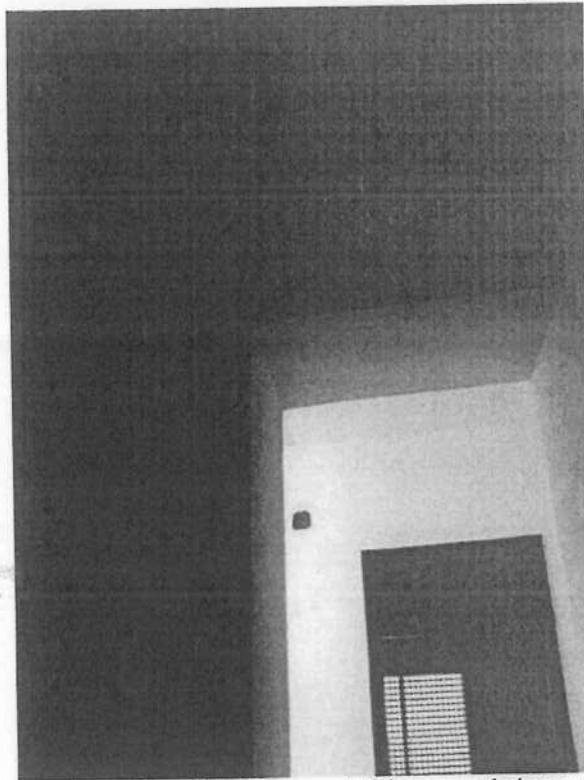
Infiltrazioni d'acqua nel disimpegno al piano primo.
